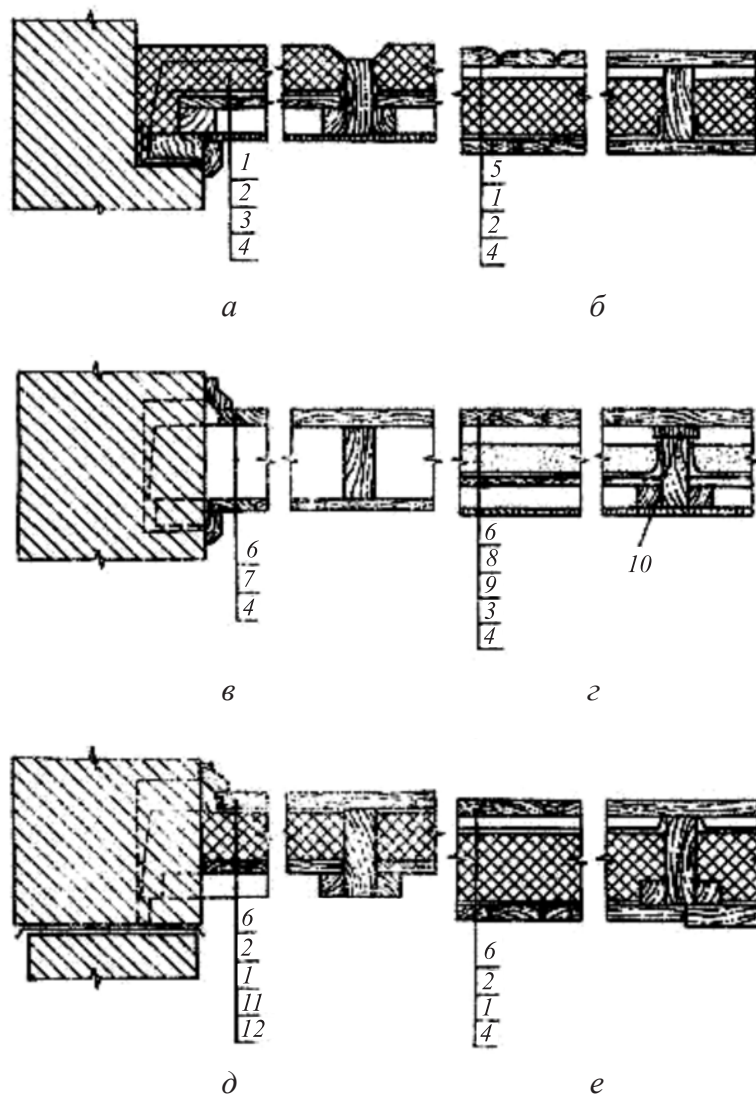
Фрагмент перекрытия по деревянным балкам: *a* — чердачное с «черным» потолком; *б* — чердачное с подшивным дощатым потолком и ходовым настилом; *в* — междуэтажное без звукоизоляции; *г* — междуэтажное с повышенной звукоизоляцией; *д* — цокольное с «черным» полом; *е* — цокольное с дощатой подшивкой: 1 — утеплитель; 2 — пароизоляция; 3 — «черный» потолок; 4 — подшивка; 5 — ходовой настил; 6 — доски пола; 7 — балка; 8 — сухой песок; 9 — подстилка; 10 — упругая подкладка; 11 — «черный» пол; 12 — черепной брусок
